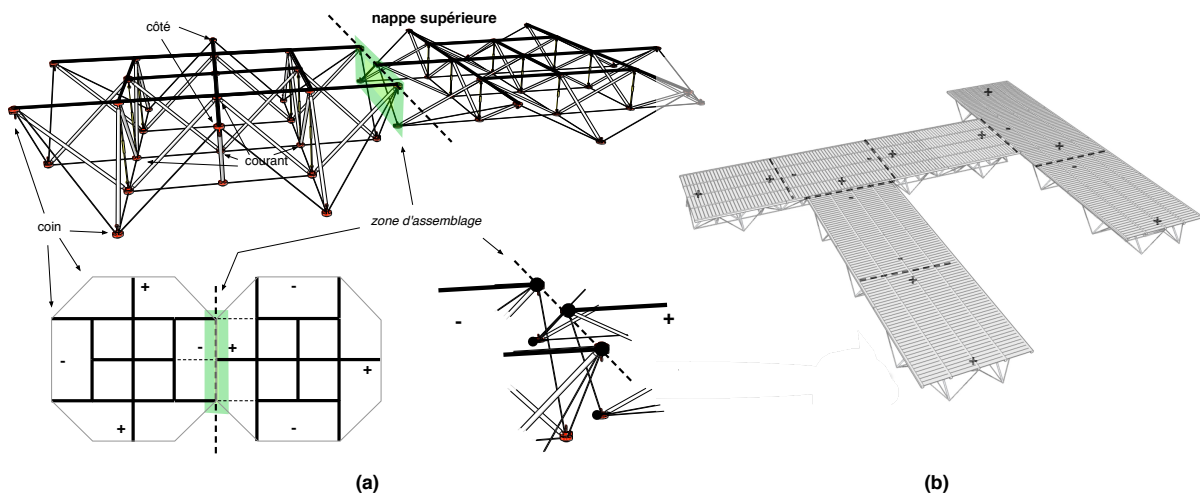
Principe d'assemblage entre modules (a) - Calepinage pour la formation d'une plateforme de géométrie complexe (b)
